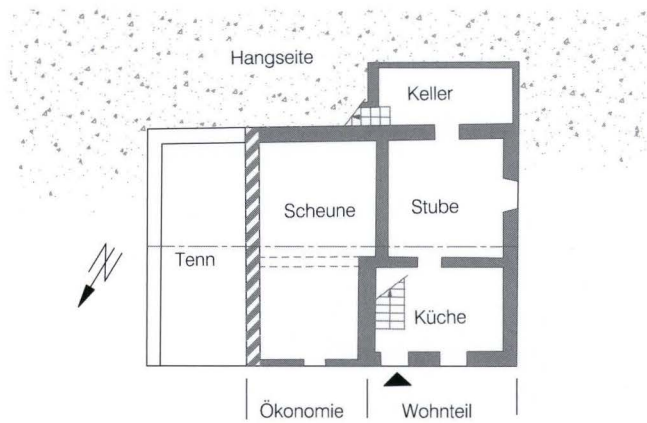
Hauptstrasse 74. Grundriss mit Rekonstruktion. – Zeichnung: Hans Ritzmann.
